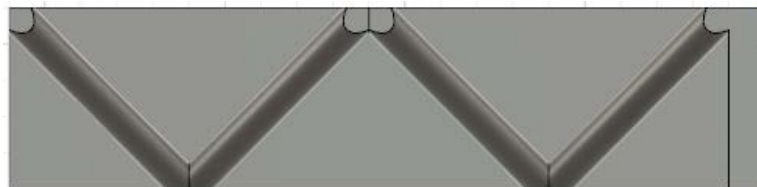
10 mm, slab 3D, vista in pianta.
